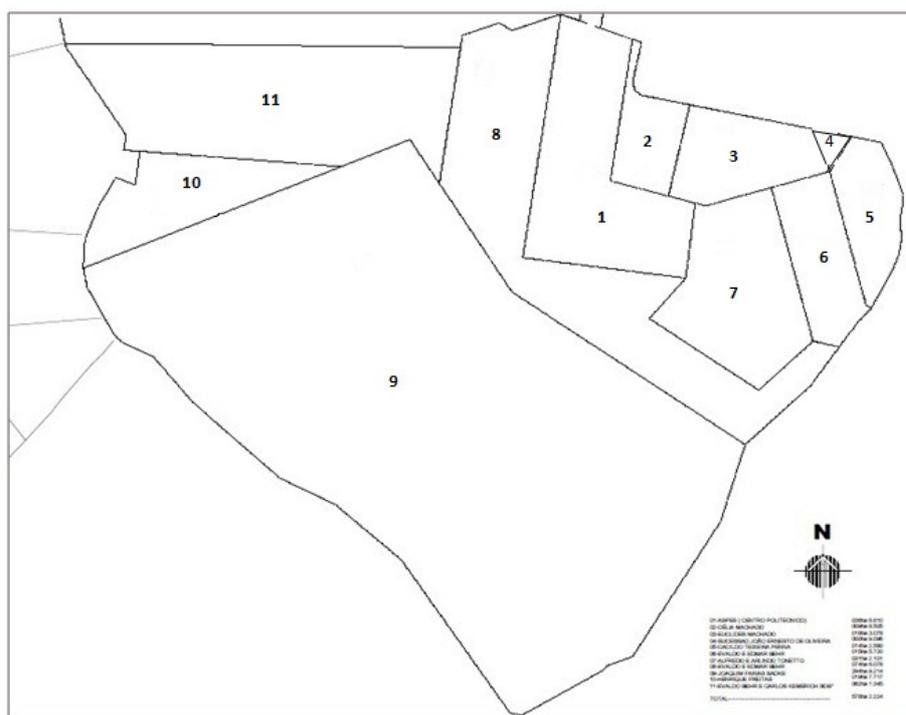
Planta das Glebas destinadas a construção do Campus Universitário
